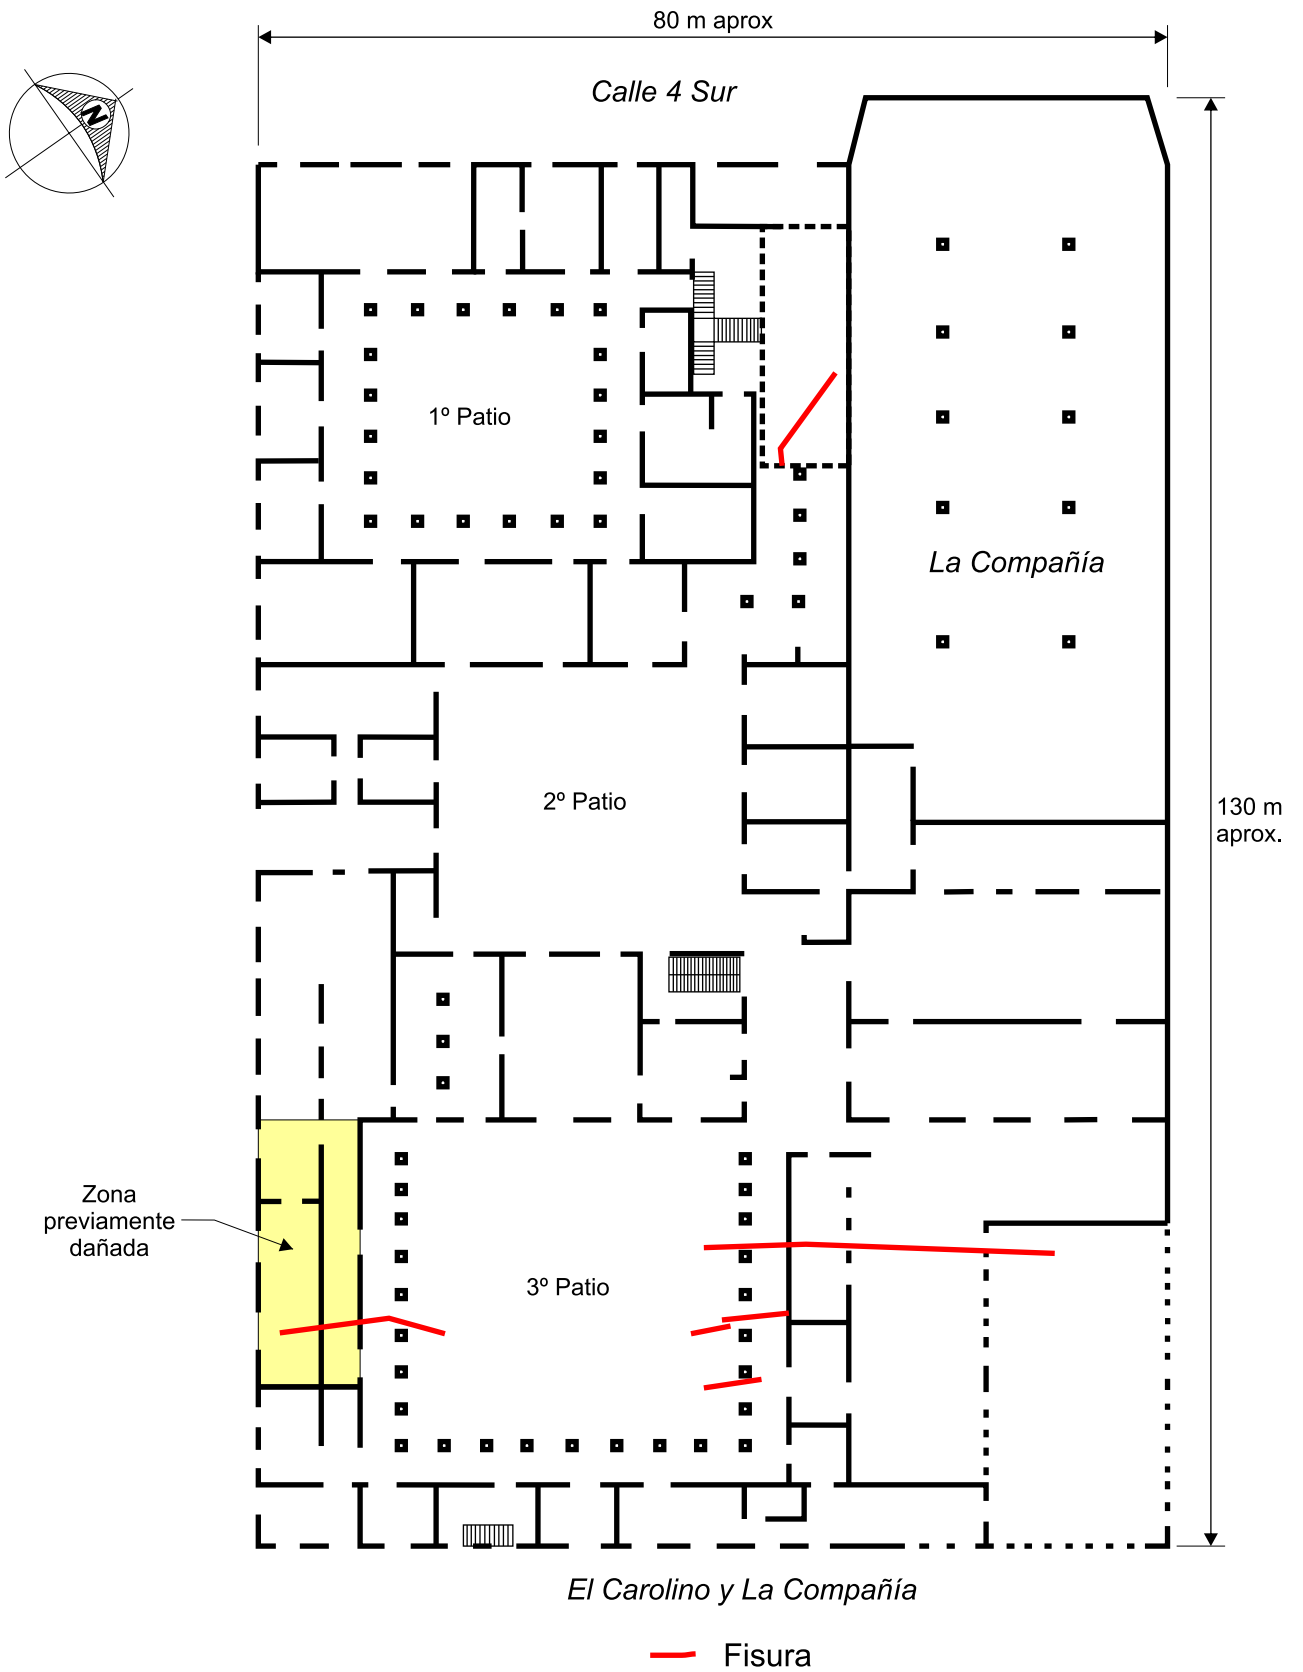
Fisuras estructurales observadas en el Carolino
